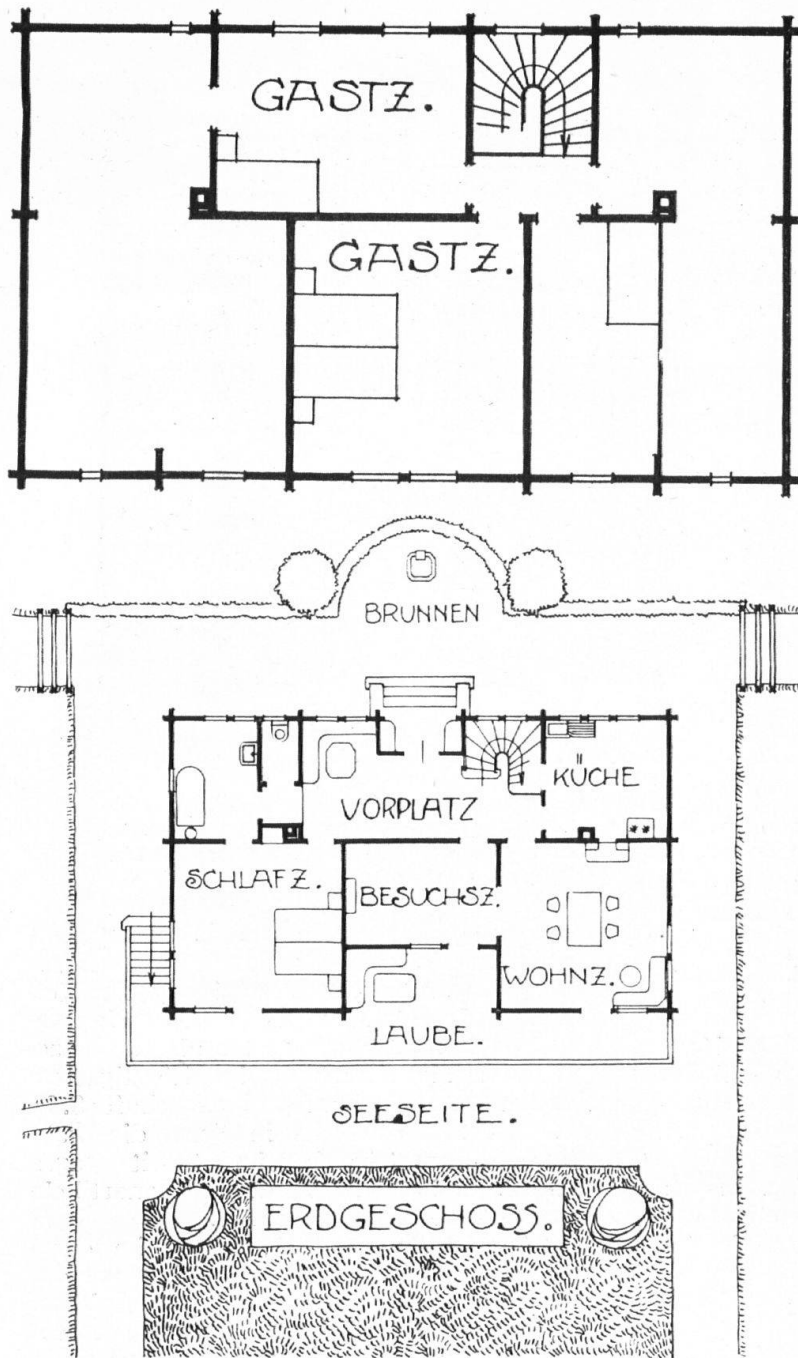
u. 12. Grundriss von Erdgeschoss und erstem Stock des Chalets von Dr. Weber in Leissigen. (Siehe Abb. 13. u. 14). — Fig. 11 et 12. Plans du rez-de-chaussée et du premier étage du chalet de M. le Dr. Weber, à Leissigen (voir fig. 13 et 14).
